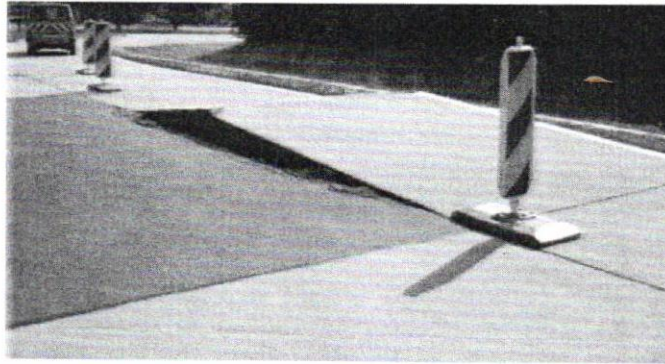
Typischer Hitzeschaden mit „Dachprofil“ als Folge-schaden eines Plattenersatzes im benachbarten Fahrstreifen in Asphaltbauweise
